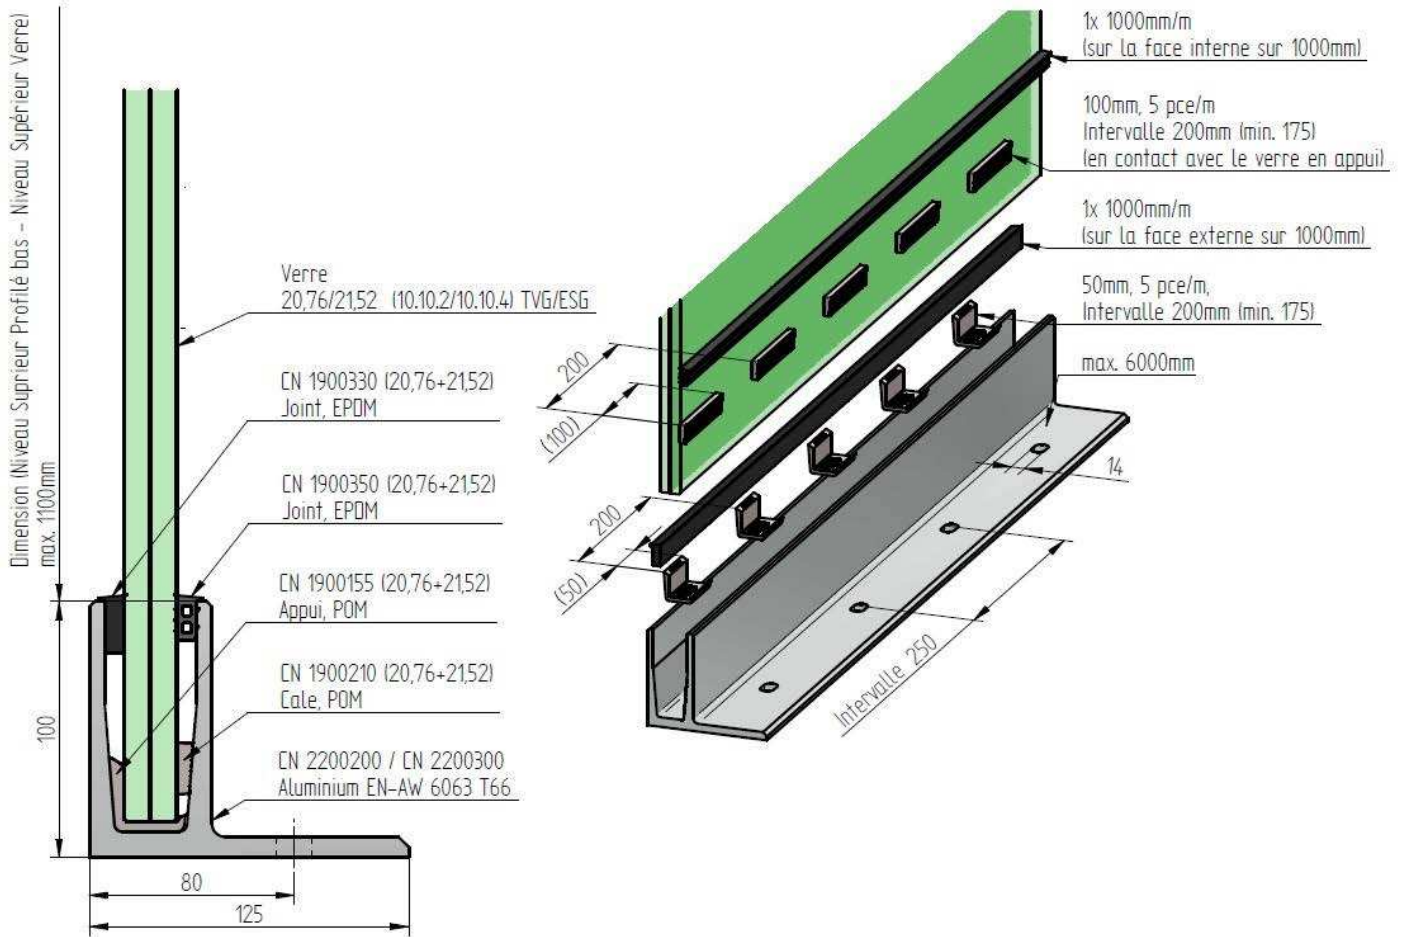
CROSI LUX 1.0 – Montage sur dalle – Profilé renforcé
